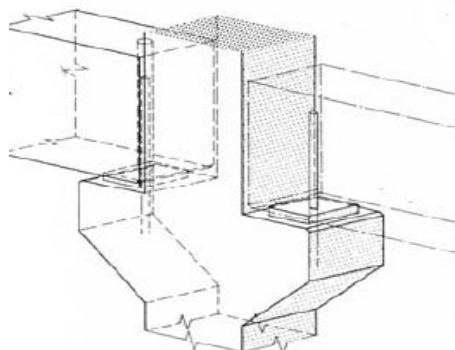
Ligação pilar-viga executada recorrendo a consola curta de betão (STUPRÉ, 1981).
